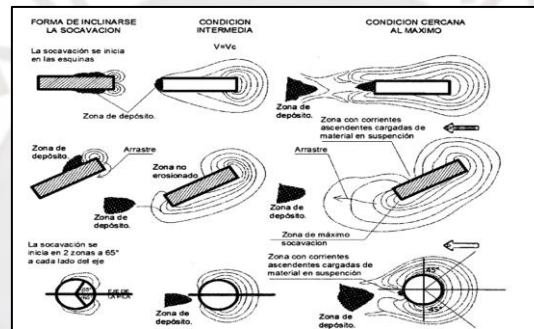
Modelos de socavación para diversas geometrías de pilares.
